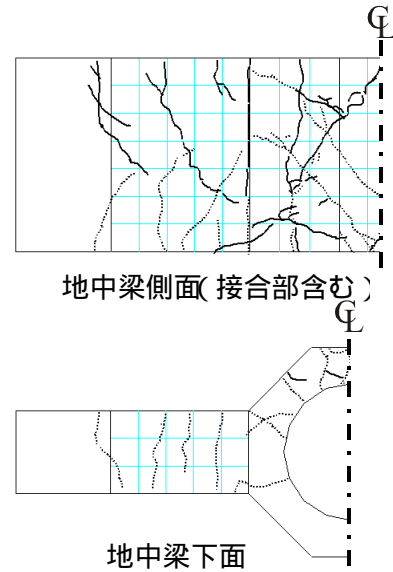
接合部のひび割れ状況 (No.1)
